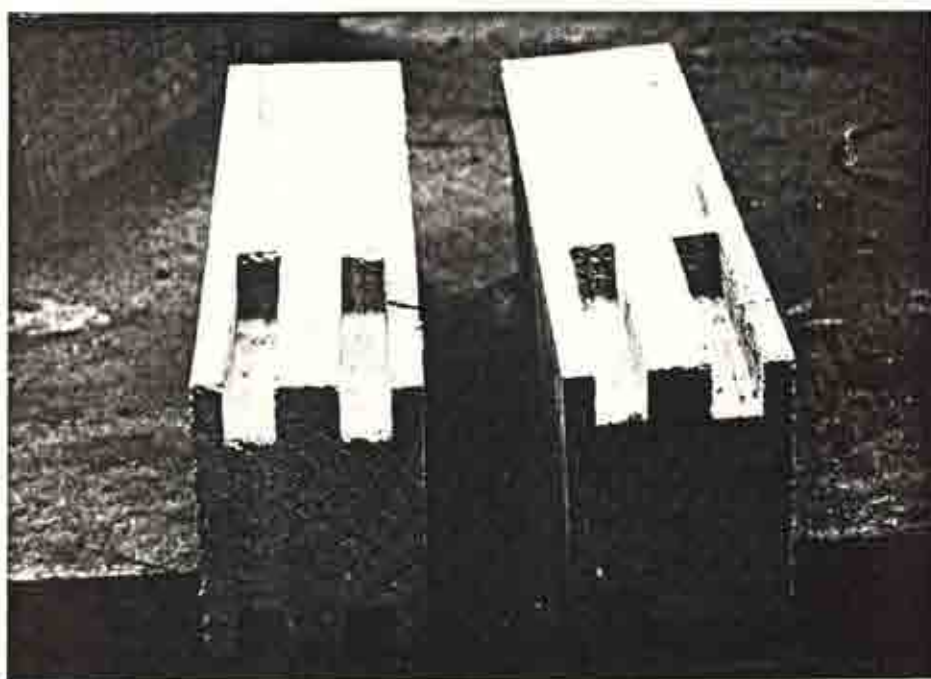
Detalle de la sección de las probetas comentadas en la anterior fotografía.
